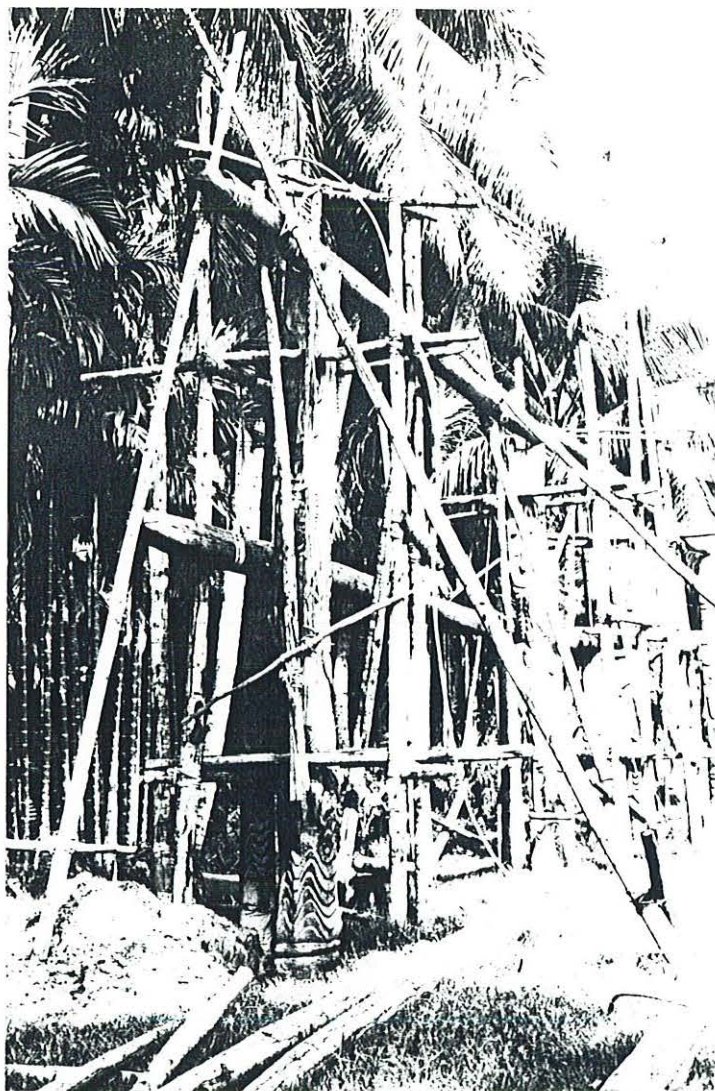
Maison cérémonielle de Korogo en construction (1988). Les poutres sablières et les poutres de support de la plateforme sont déjà en place.
